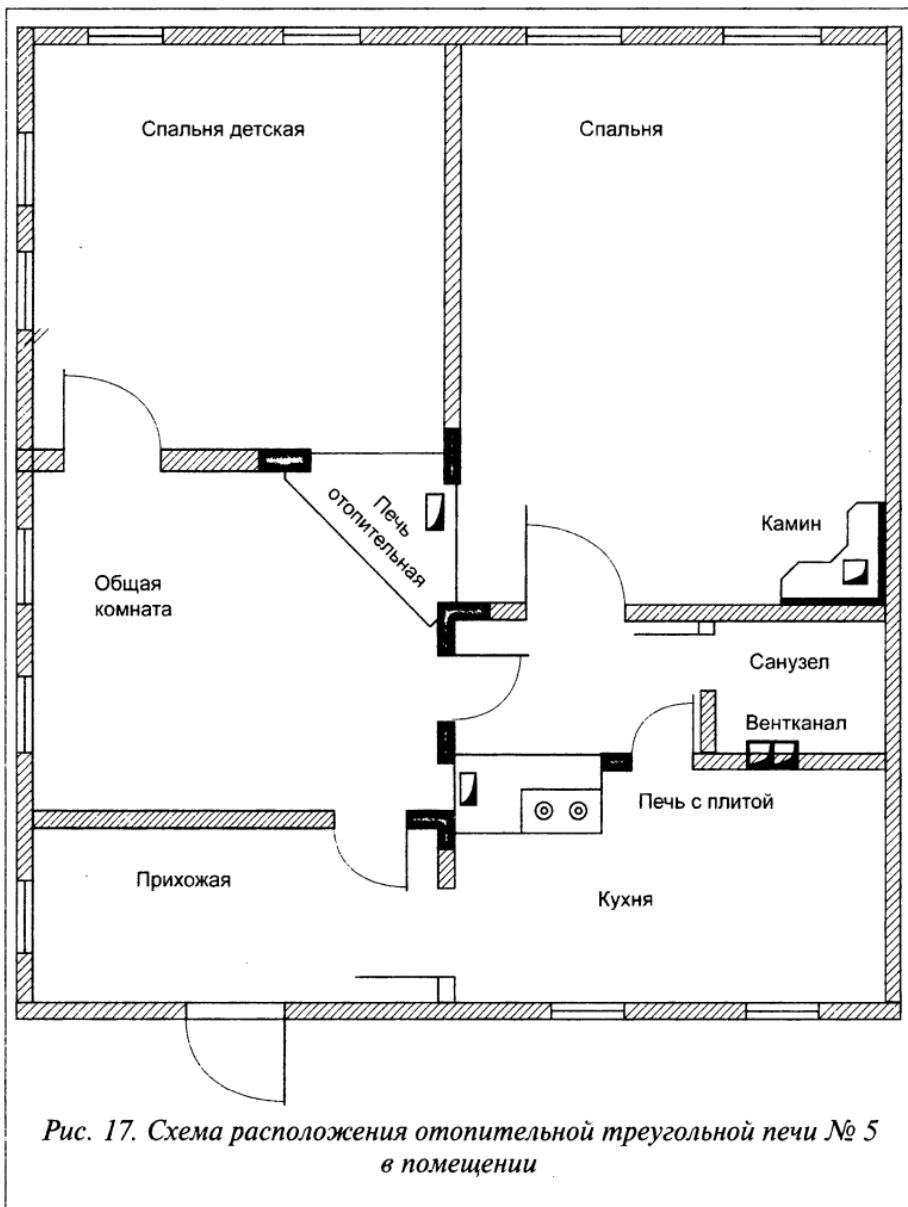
Схема расположения отопительной треугольной печи № 5 в помещении
